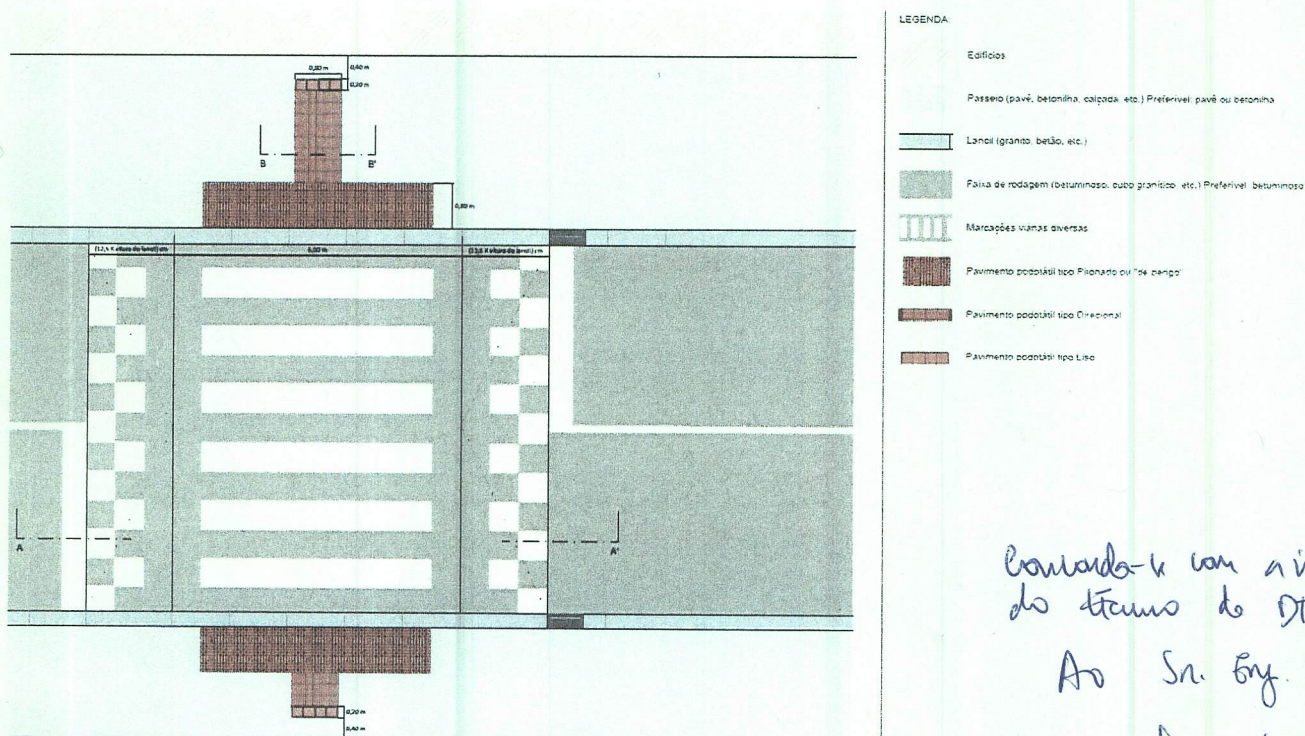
Planta de travessia-tipo com Pavimentos Podotáteis
